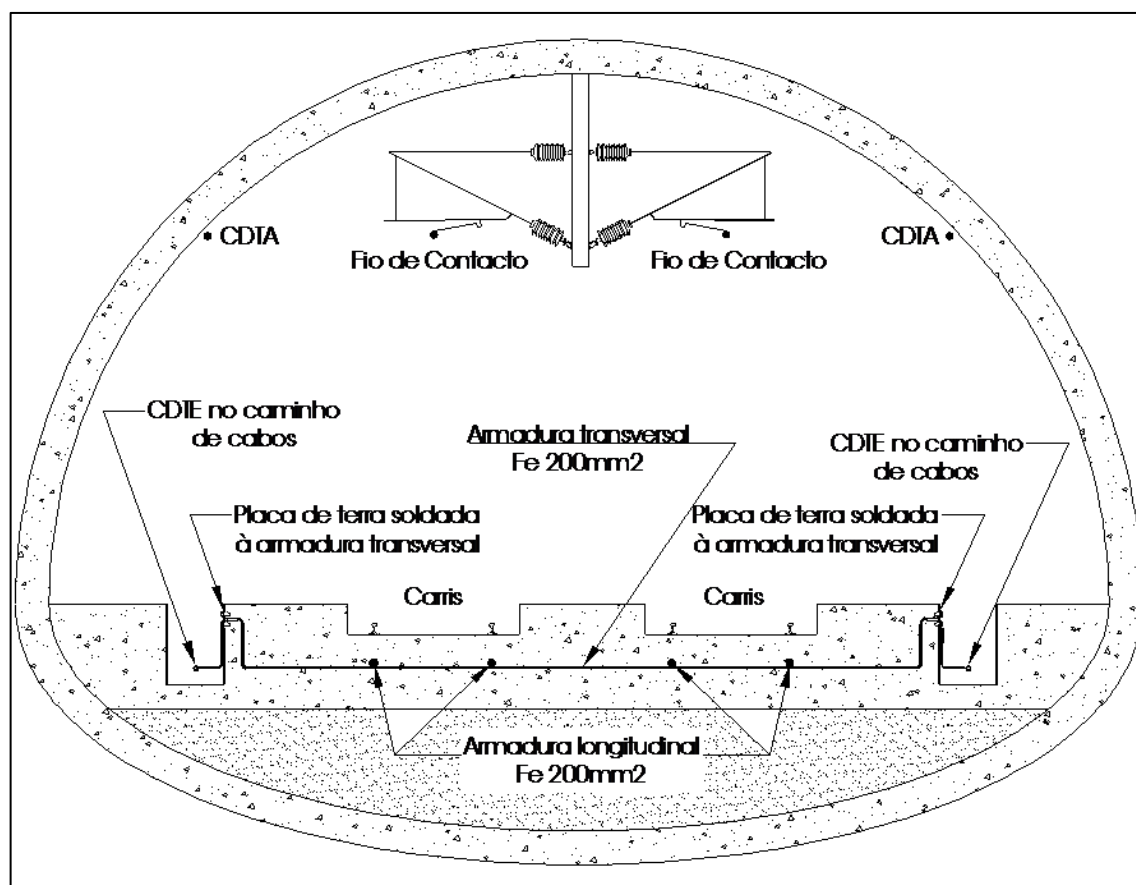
Secção transversal do túnel: não existem ligações à terra das paredes de betão
